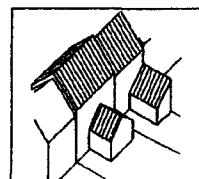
bâtiment secondaire adossé au mur gouttereau
